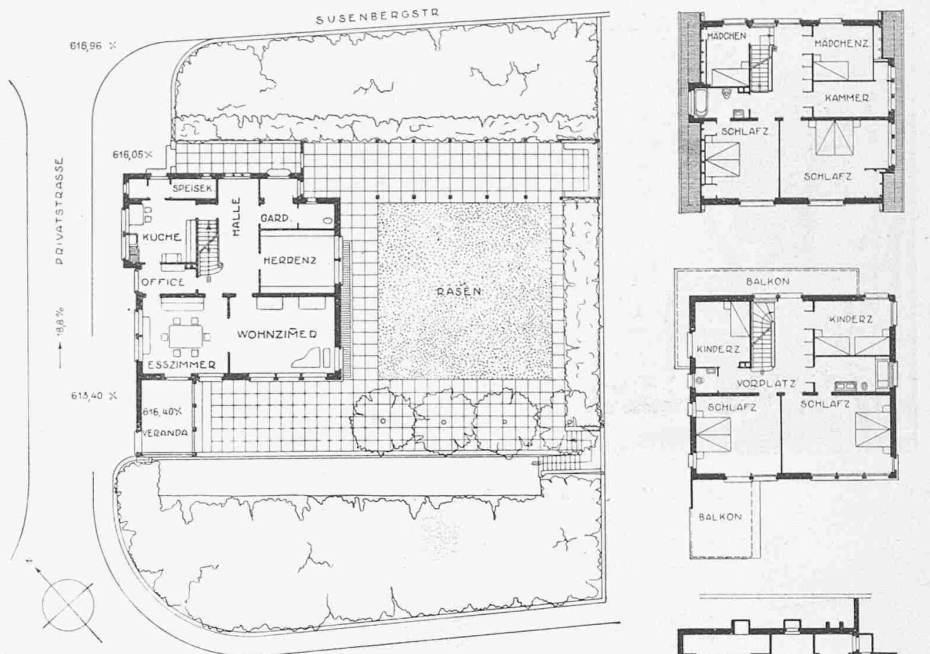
bis 10. Grundrisse vom Hause Hablützel. — Masstab 1 : 400.
